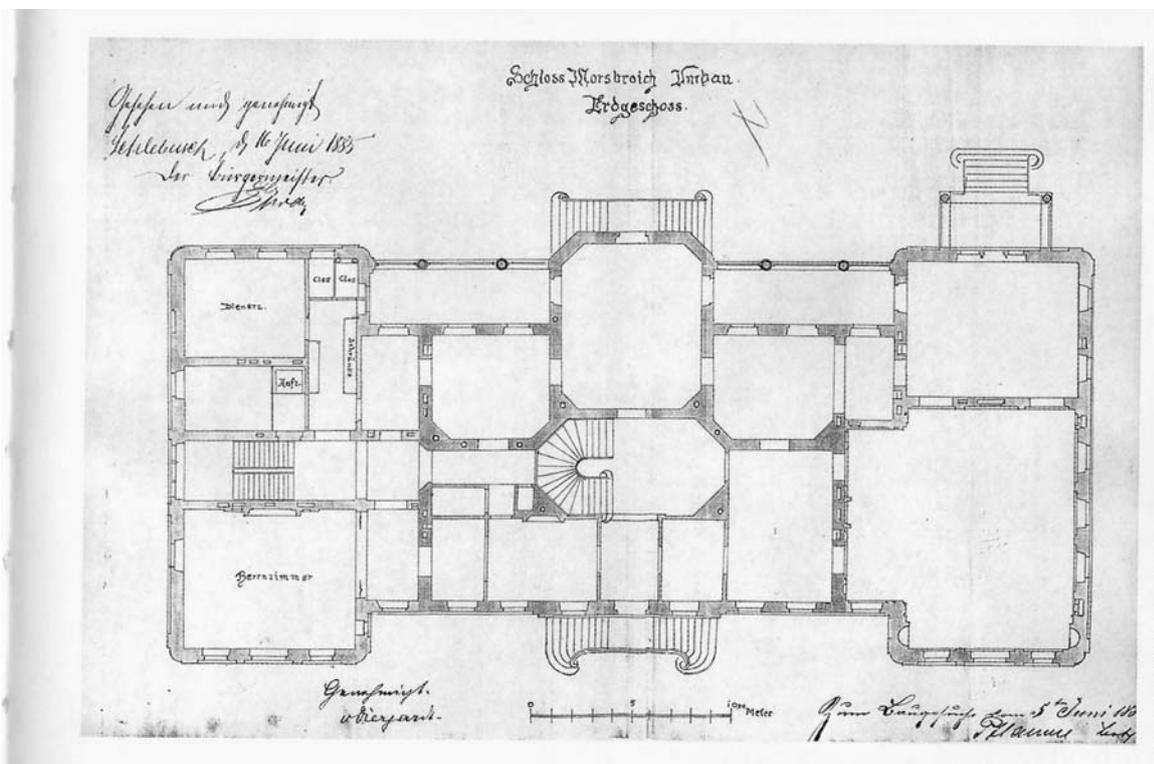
Schloss Morsbroich in Leverkusen, Grundriss Erdgeschoss mit den Umbauten von H.O. Pflaume, 1885
